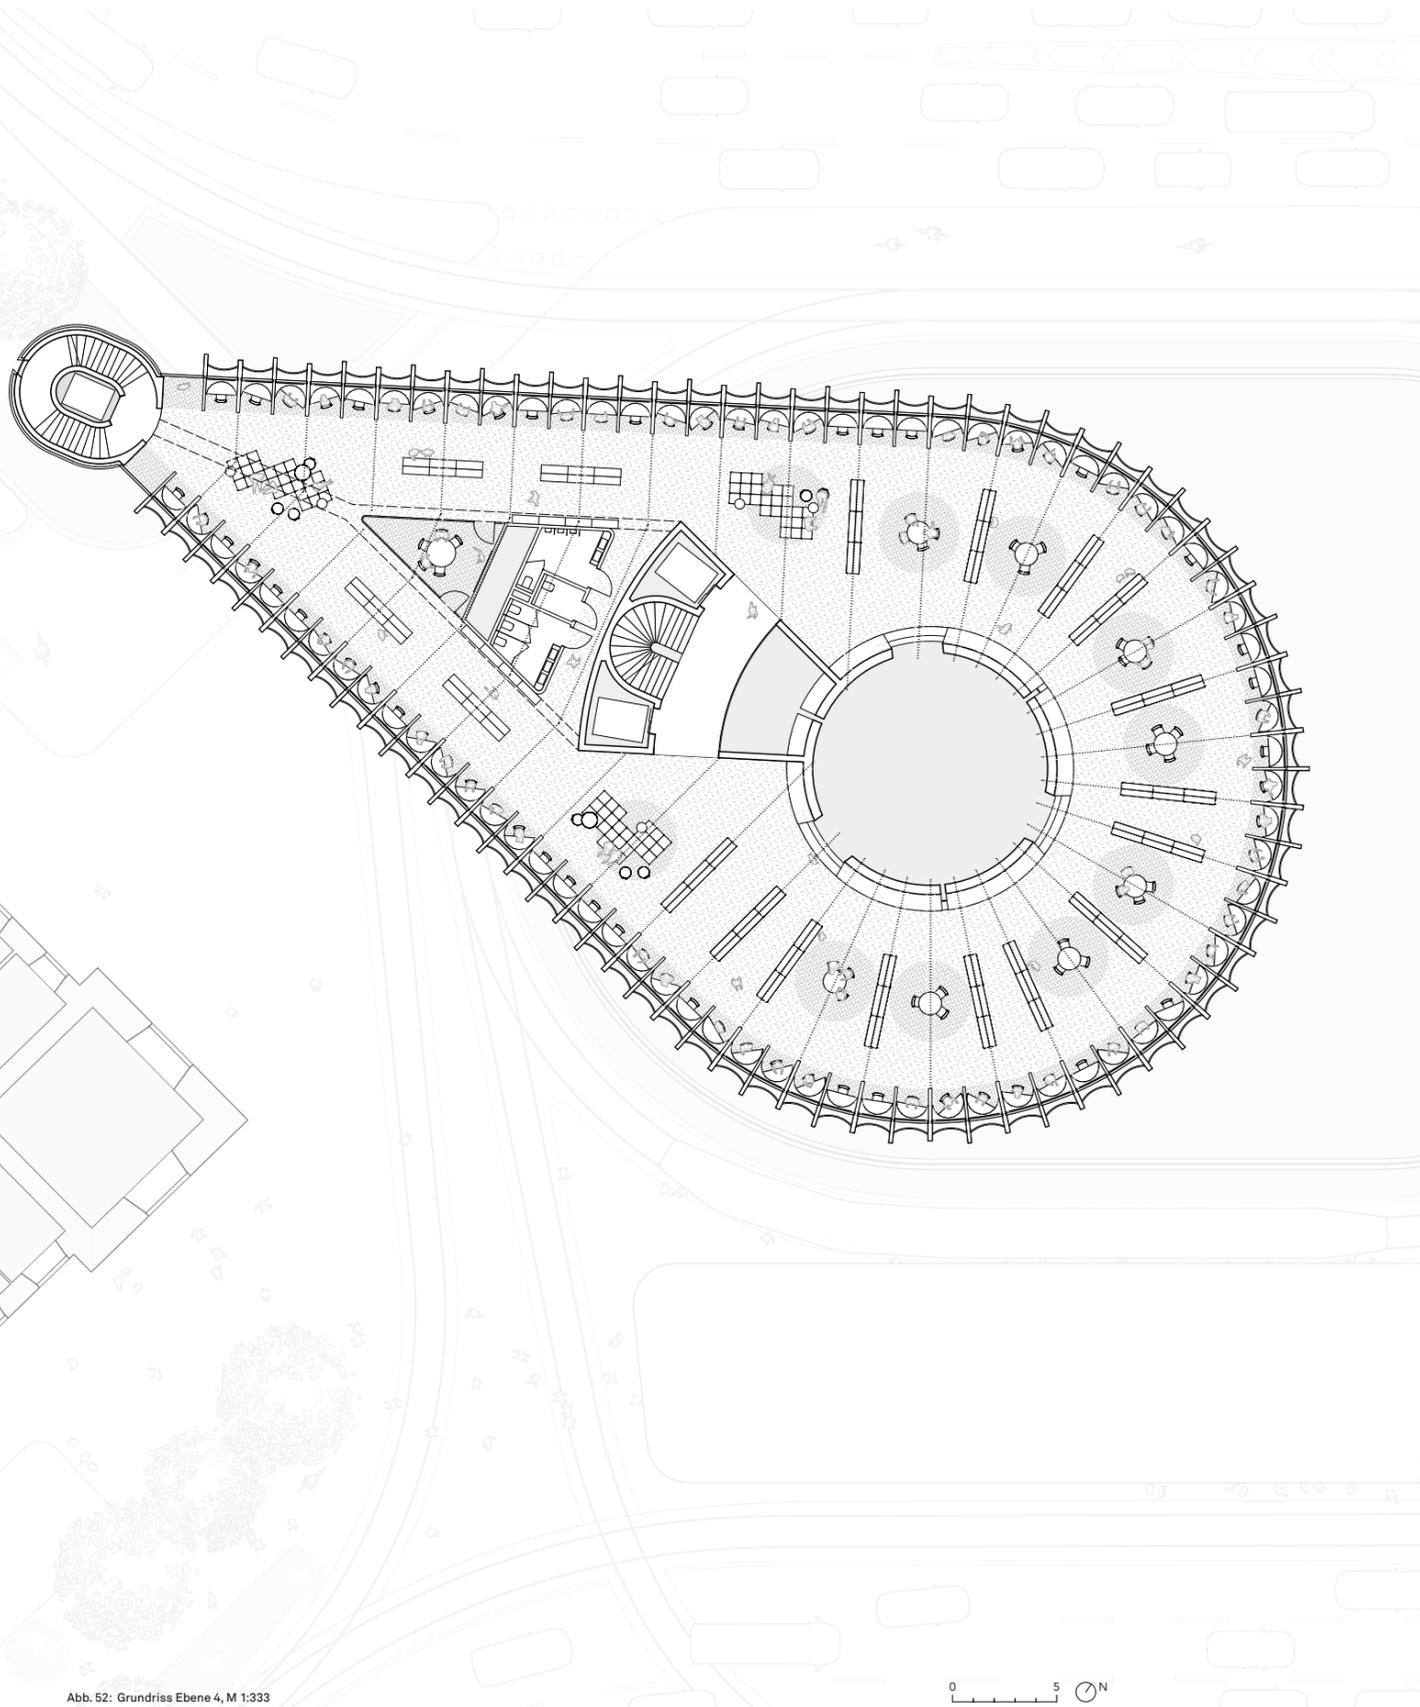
Grundriss Ebene 4, M 1:333
